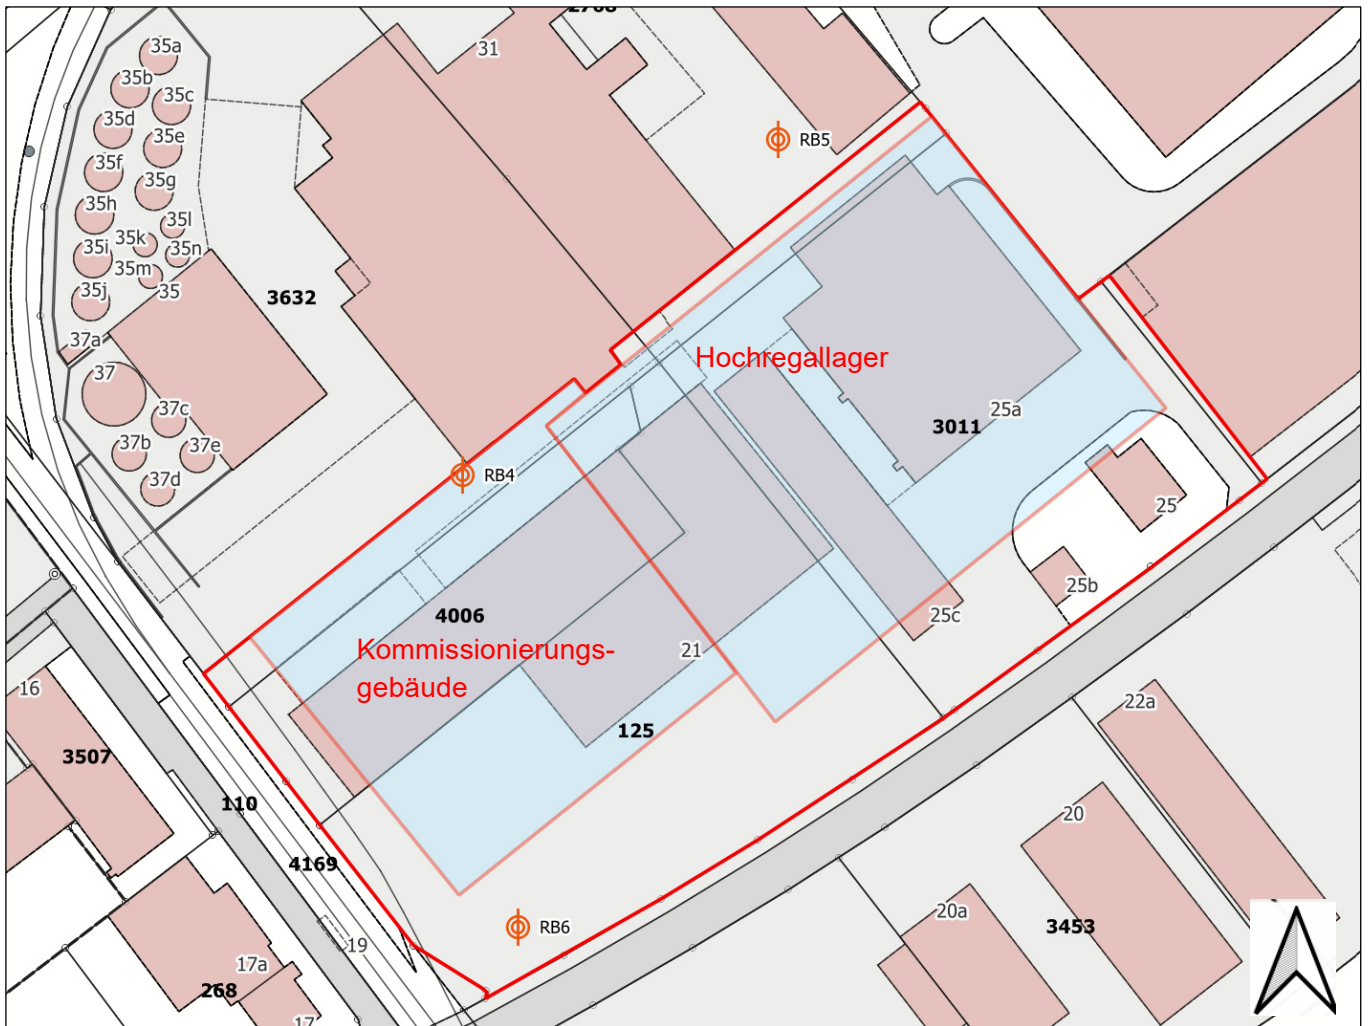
Umrisse geplante Bauten (nicht massstäblich)
